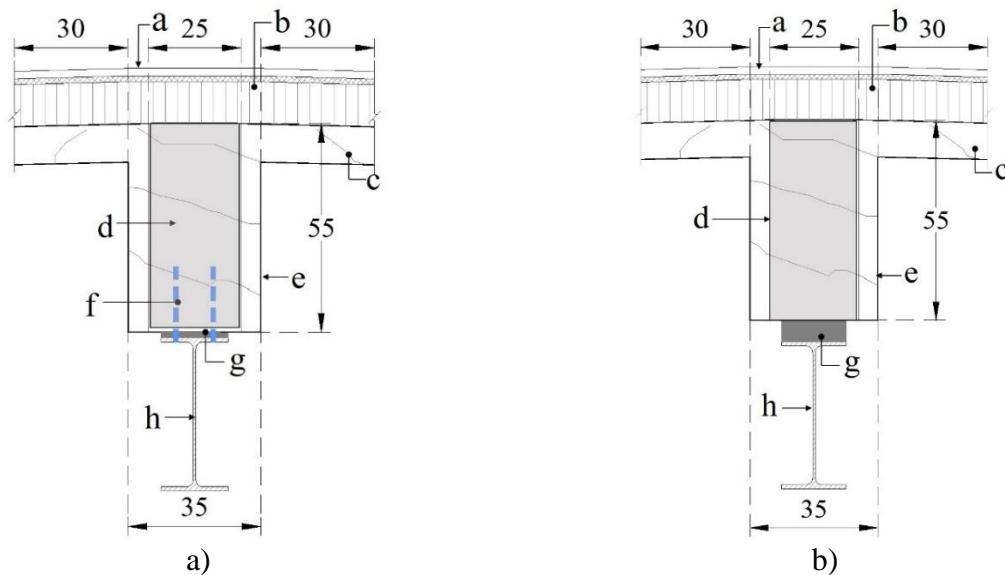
Reforço de viga secundária; a) vista transversal de viga mista; b) vista transversal de viga de contato; onde: a = acabamento de piso, b = preenchimento de concreto simples, c = laje de concreto armado, d = seção transformada de viga de concreto considerada de acordo com a diminuição do momento de inércia, e = viga fissurada de concreto armado, f = projeção de conectores entre os dois elementos, g = preenchimento de microconcreto não metálico, h = perfil de aço A-50 (IR 406 mm x 53.70 kg/m). Cotas em cm.
